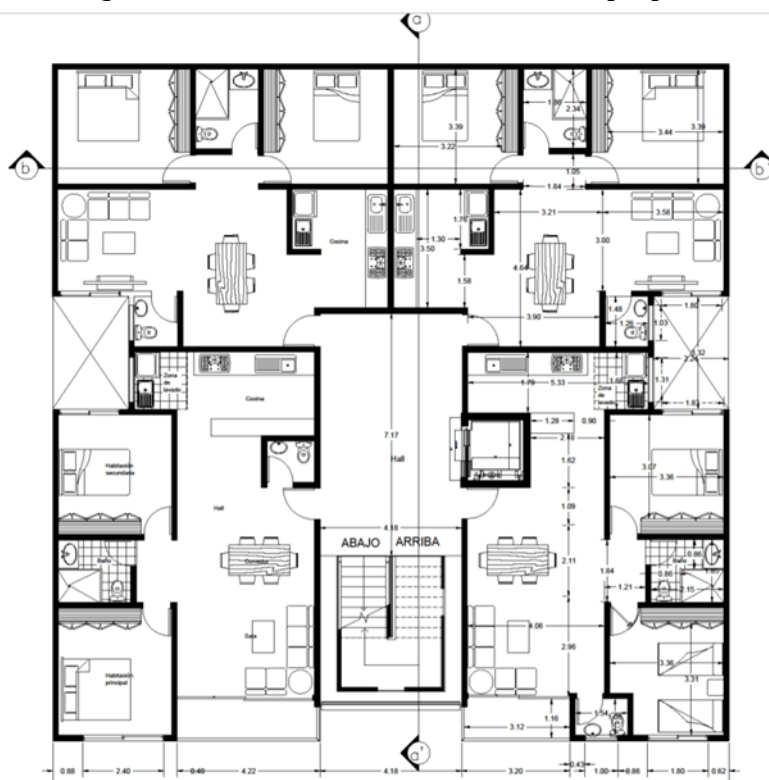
Vista en planta del diseño de las unidades de vivienda, constructora Proyectos y Soluciones de Ingeniería P.S.I. Ltda. Fuente: Creación propia.
